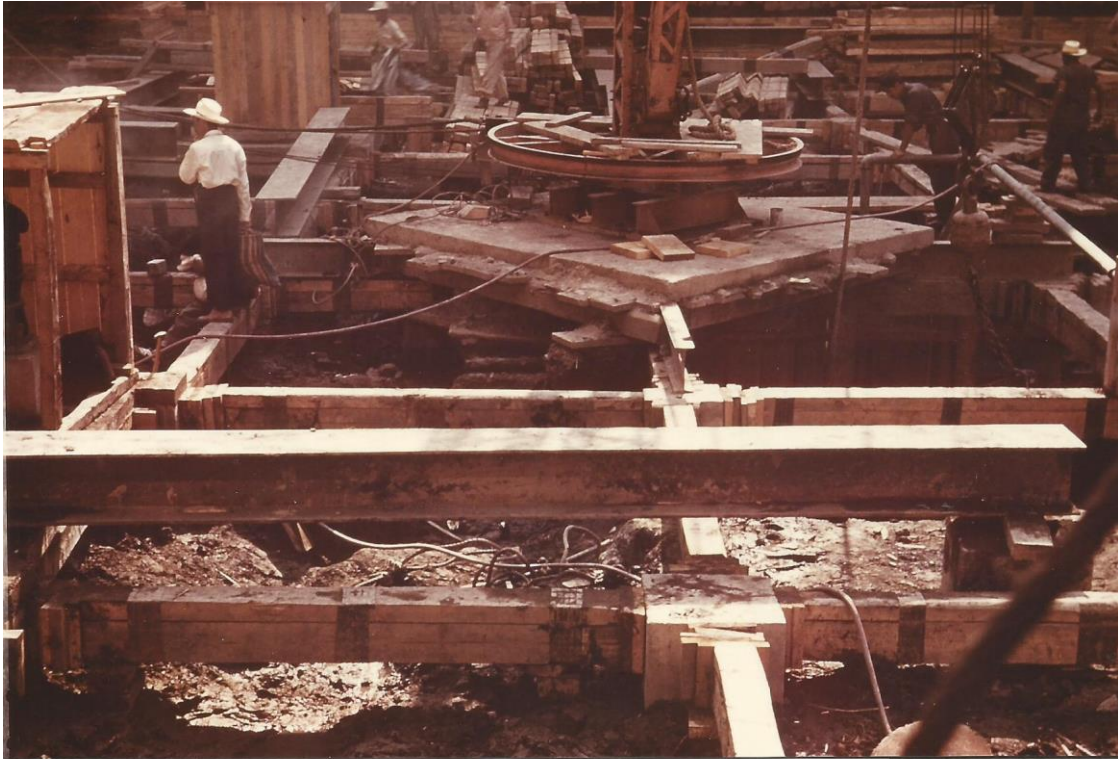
COLOCACIÓN DE VIGUETAS DE APOYO.
